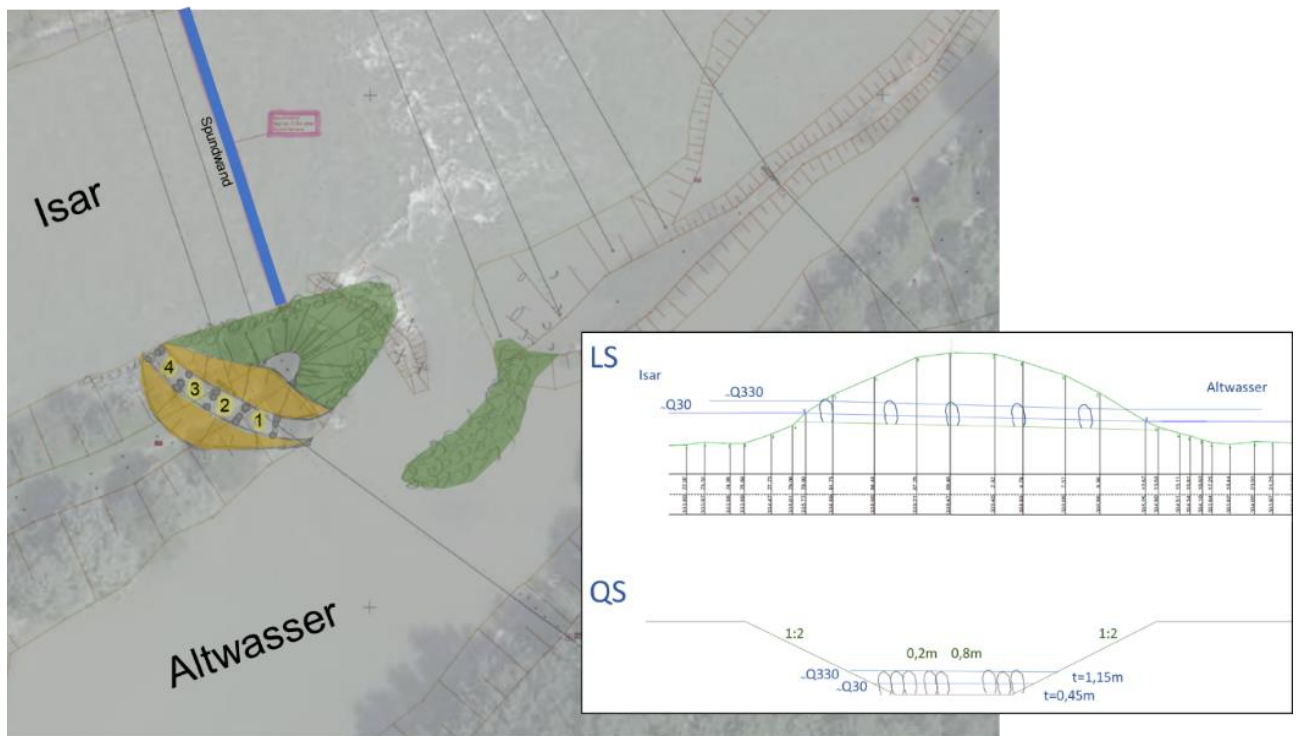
Übersichts-Lageplan der untersuchten Variante 6
